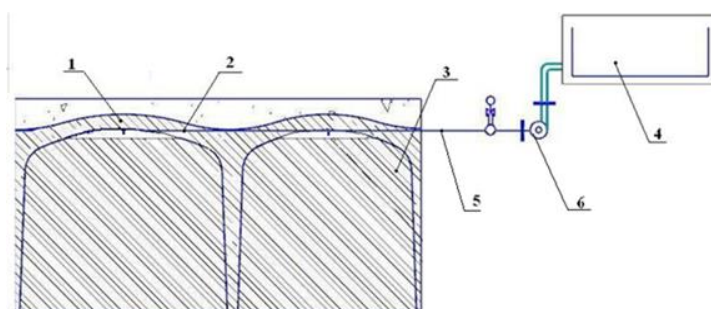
Функциональная схема системы управления (1 - сегментно-сферический фундамент, 2 - пульпопроводы в теле фундамента, 3 - грунтовое основание фундамента, 4 - резервуар с водой и песком, 5 - ёмкостные датчики, 6 - шламмовый насос).
